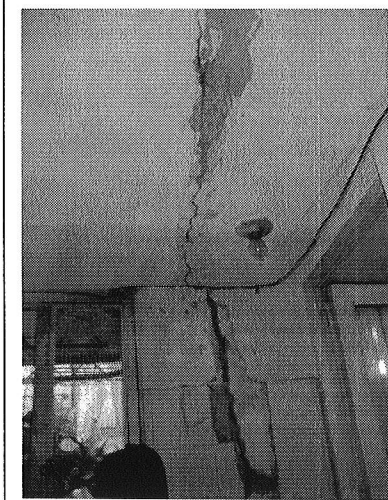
Evidencia de grietas en placas de entrepiso y muros divisorios al interior de la estructura ubicada al costado nor-oriental del predio evaluado.
